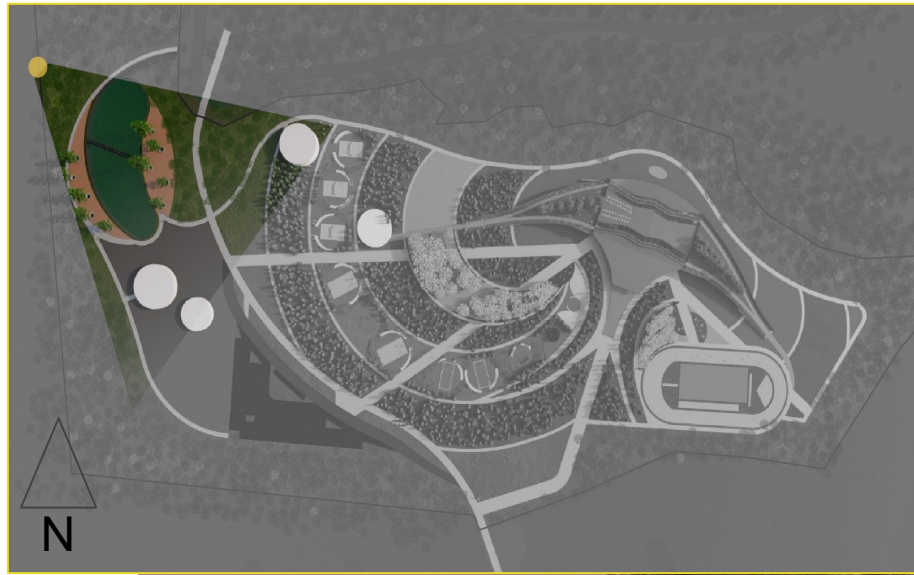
Propuesta de plan maestro de zona de energías limpias. Elaboración propia
